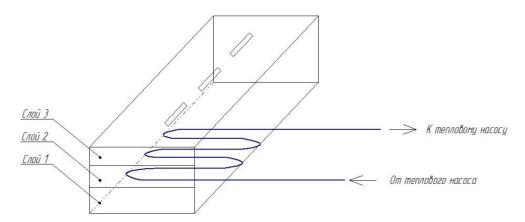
Схема укладки теплообменника под дорожным покрытием
